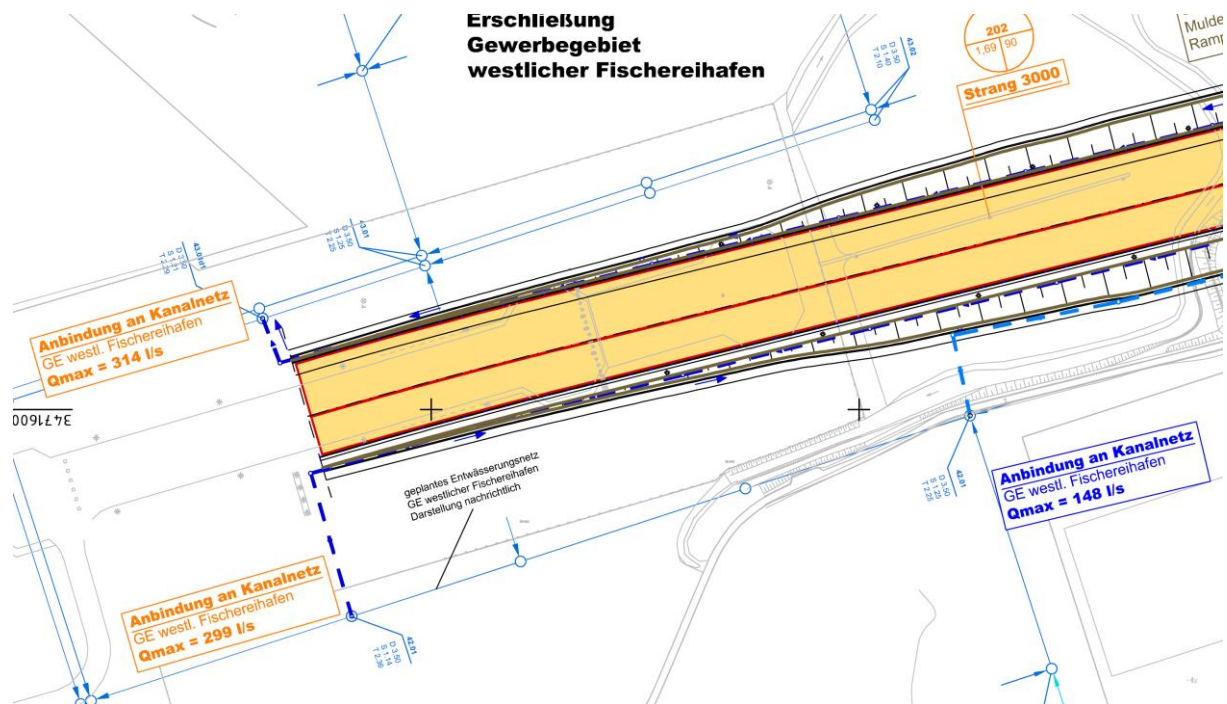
Einzugsgebiete Terminalzufahrt – Zufahrtsrampe
